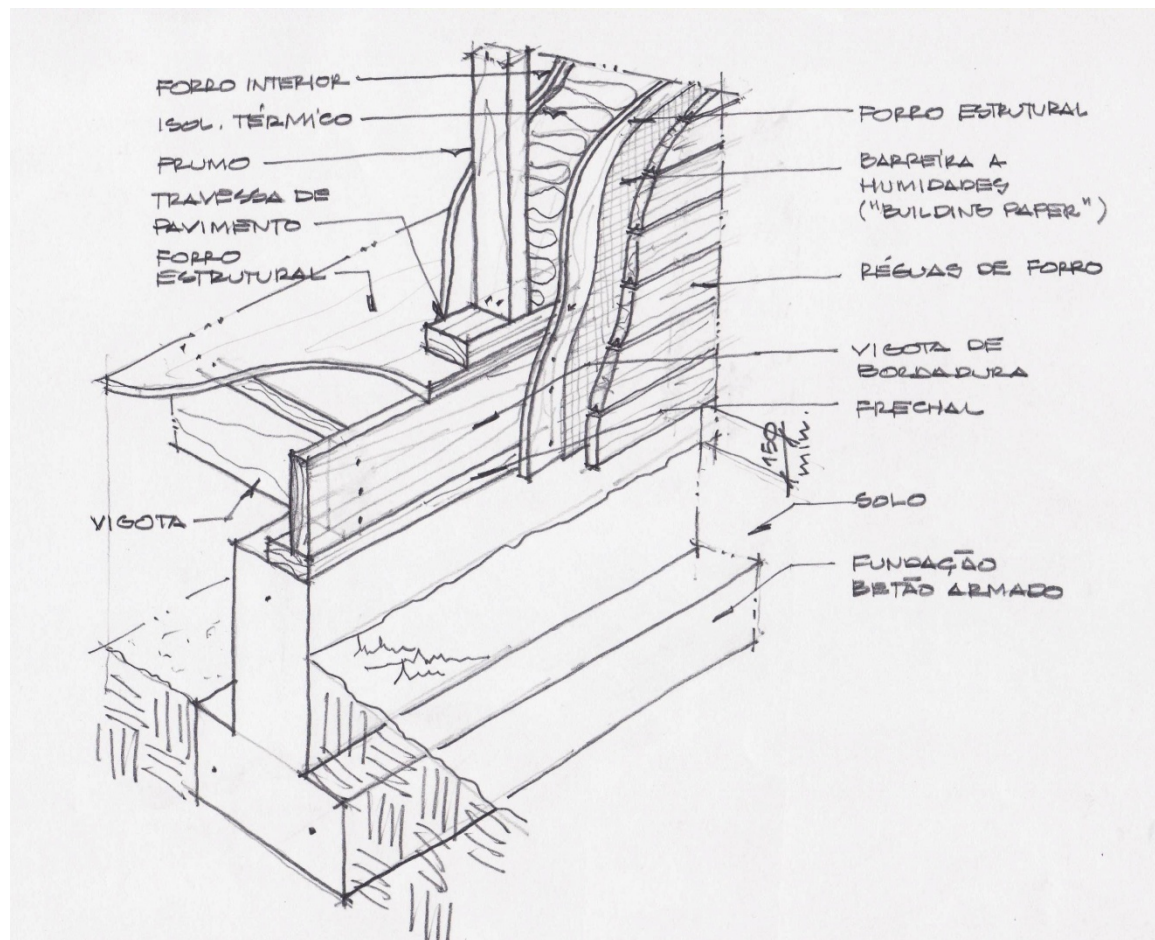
Protecção contra a deterioração da construção através dos afastamentos da madeira ao solo. (des. autor)
